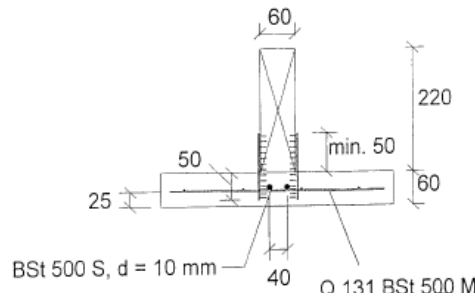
Dennert Holz-Beton-Verbundelemente [76]
